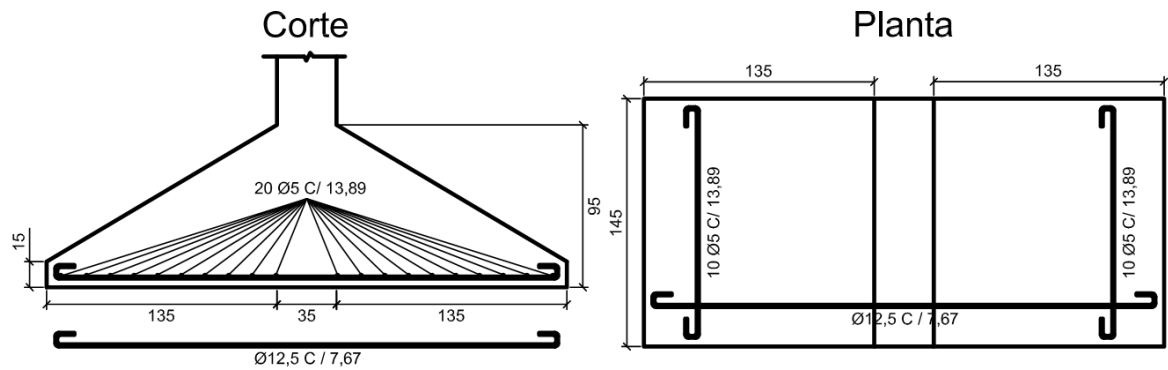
Detalhamento da sapata sobre viga alavanca.
